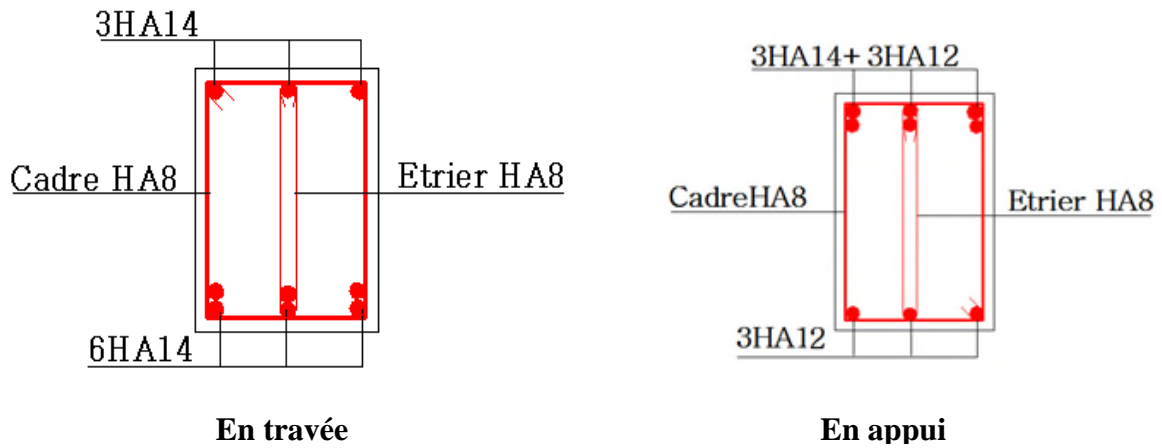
Schémas de ferrailage des poutres secondaires étages courants.
